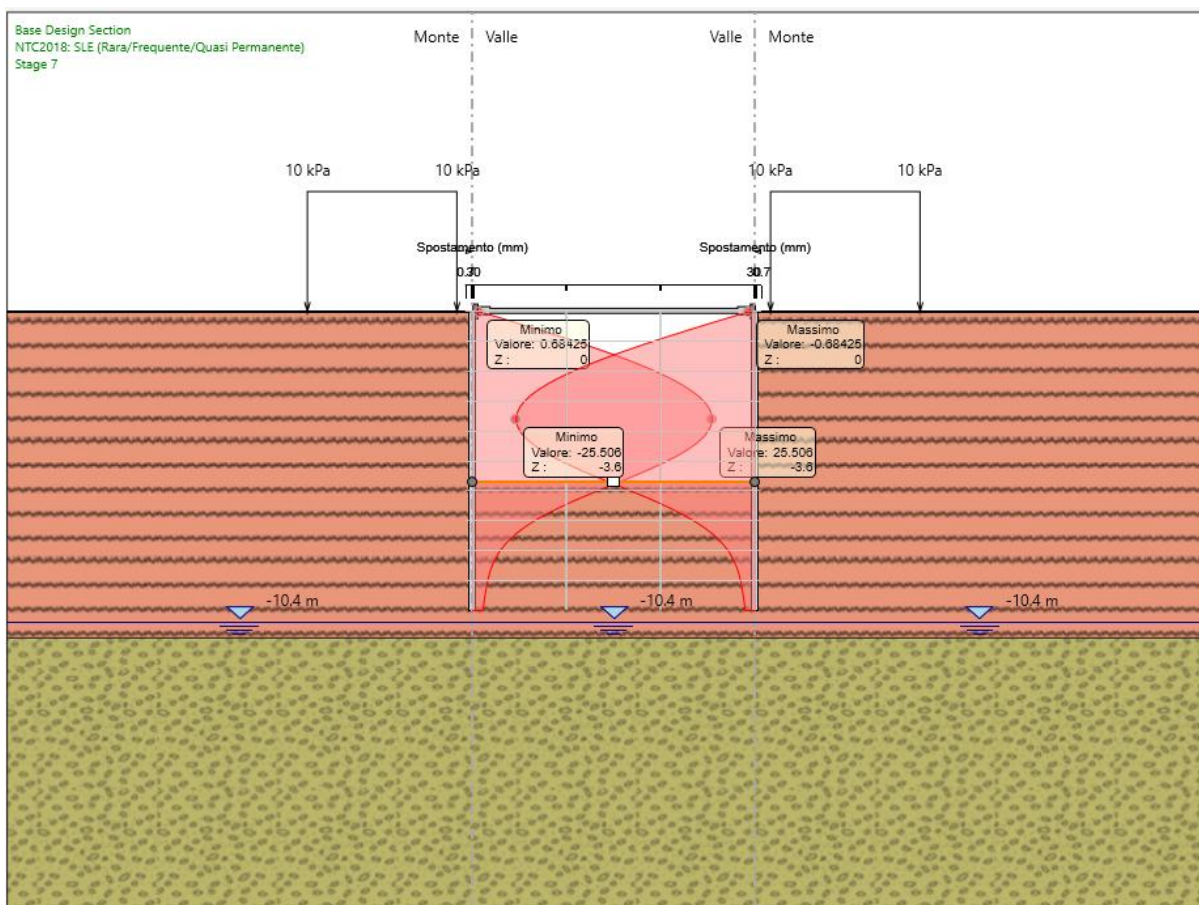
Sezione A: Spostamento massimo SLE (25.5mm)
